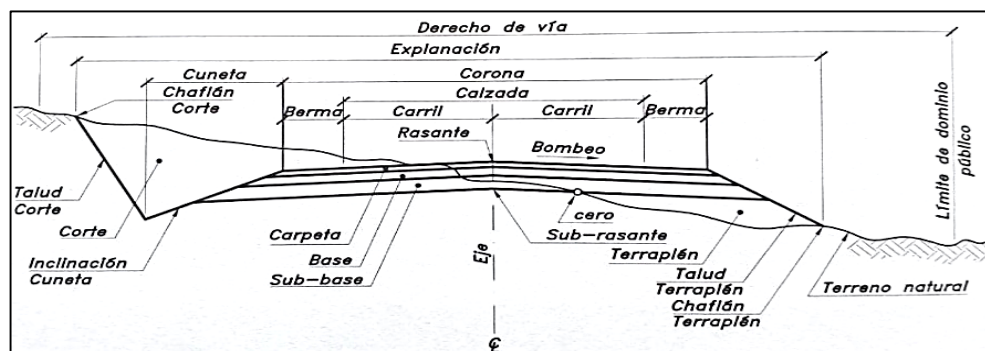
Sección transversal típica mixta, pavimentada en recta
